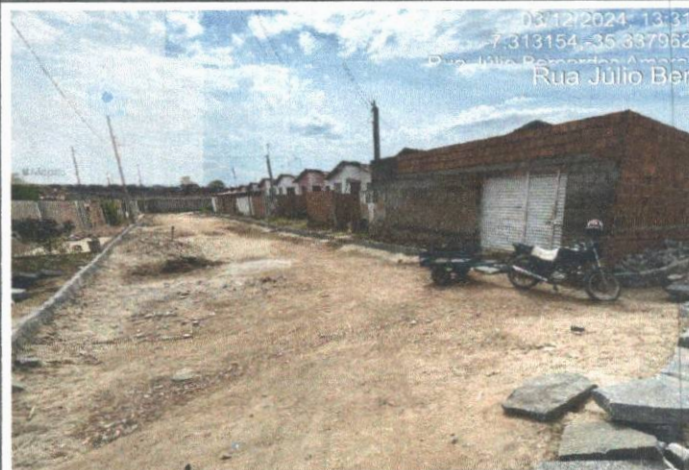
EXECUÇÃO DO MEIO-FIO
